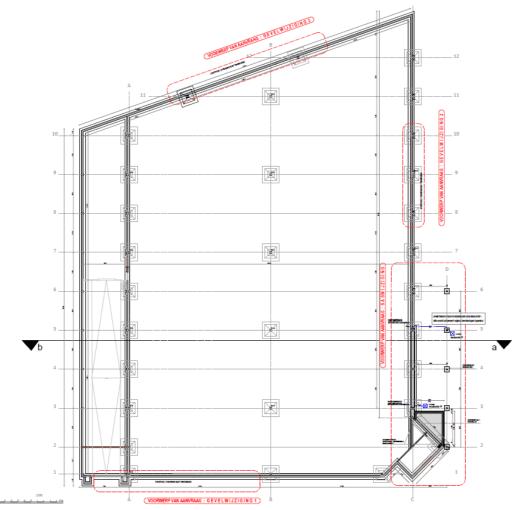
Technische tekening van de geplande situatie met aanduiding van de geplande en bestaande riolering – detail.
